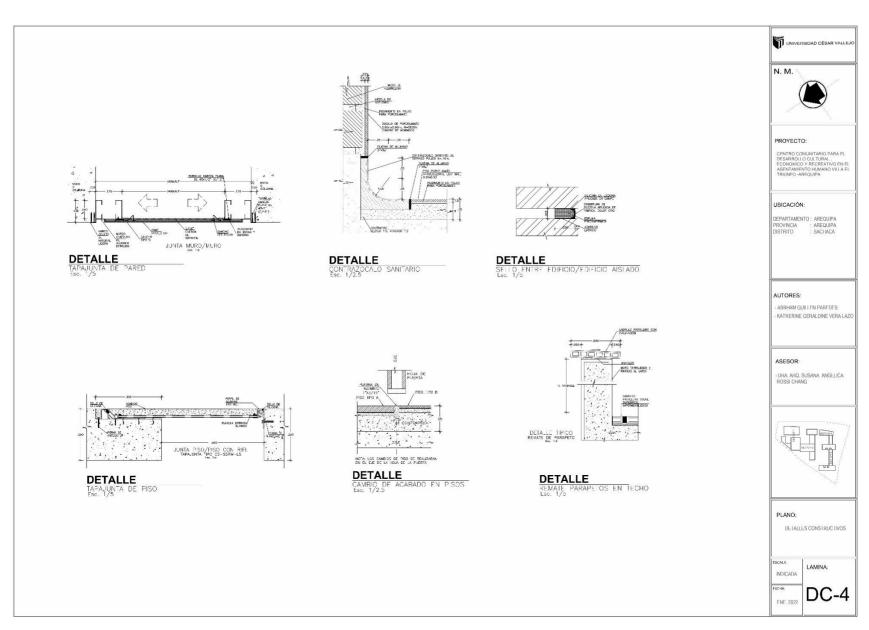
Plano de Detalles Constructivos (Acabados II) - Elaboración propia
